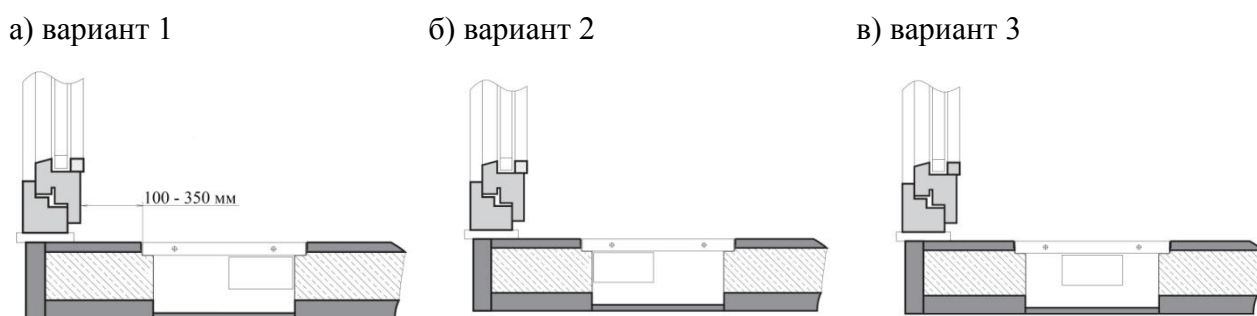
Варианты расположения нагревательного элемента в установочном коробе
